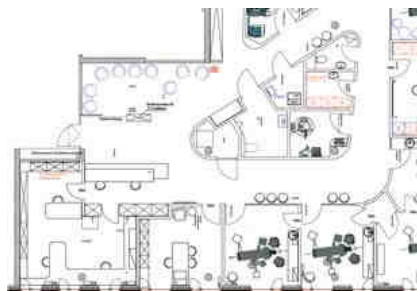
Ein Beispiel für eingelungenes Grundrisskonzept.
